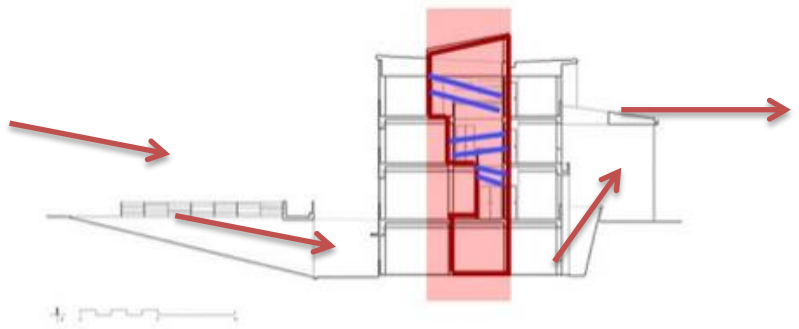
Alejandro Aravena facultad de matemáticas Chile. Web entrevista Aravena-2006 plano corte escalera
